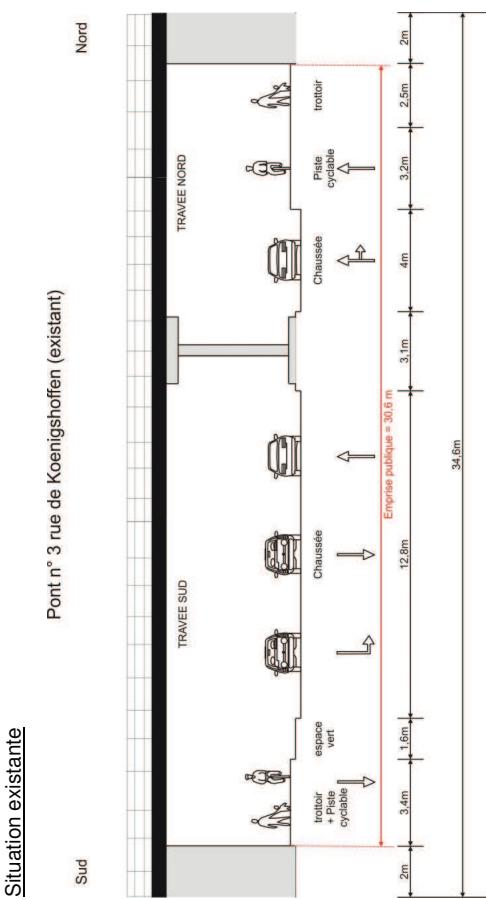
Situation existante coupe 33 sur la rue de Koenigshoffen
